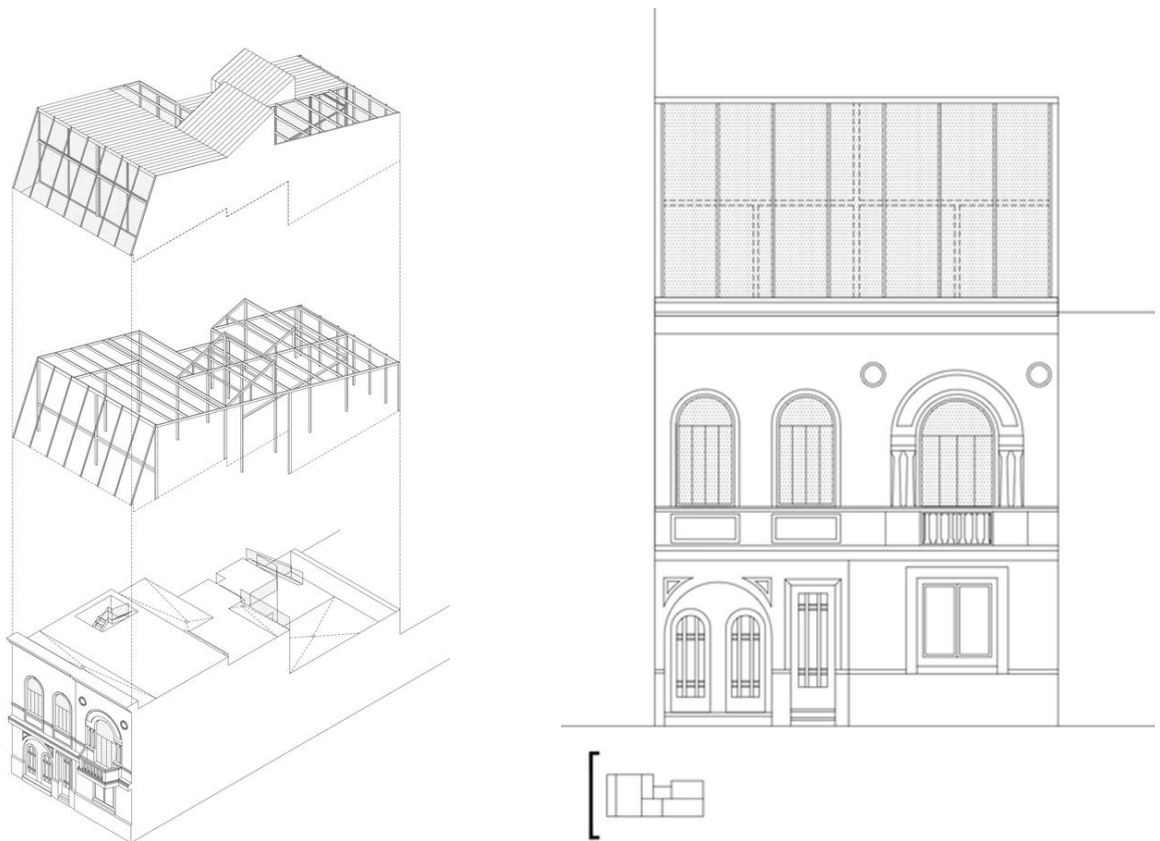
3Д-схема та фасад реконструйованої житлової будівлі [13]
